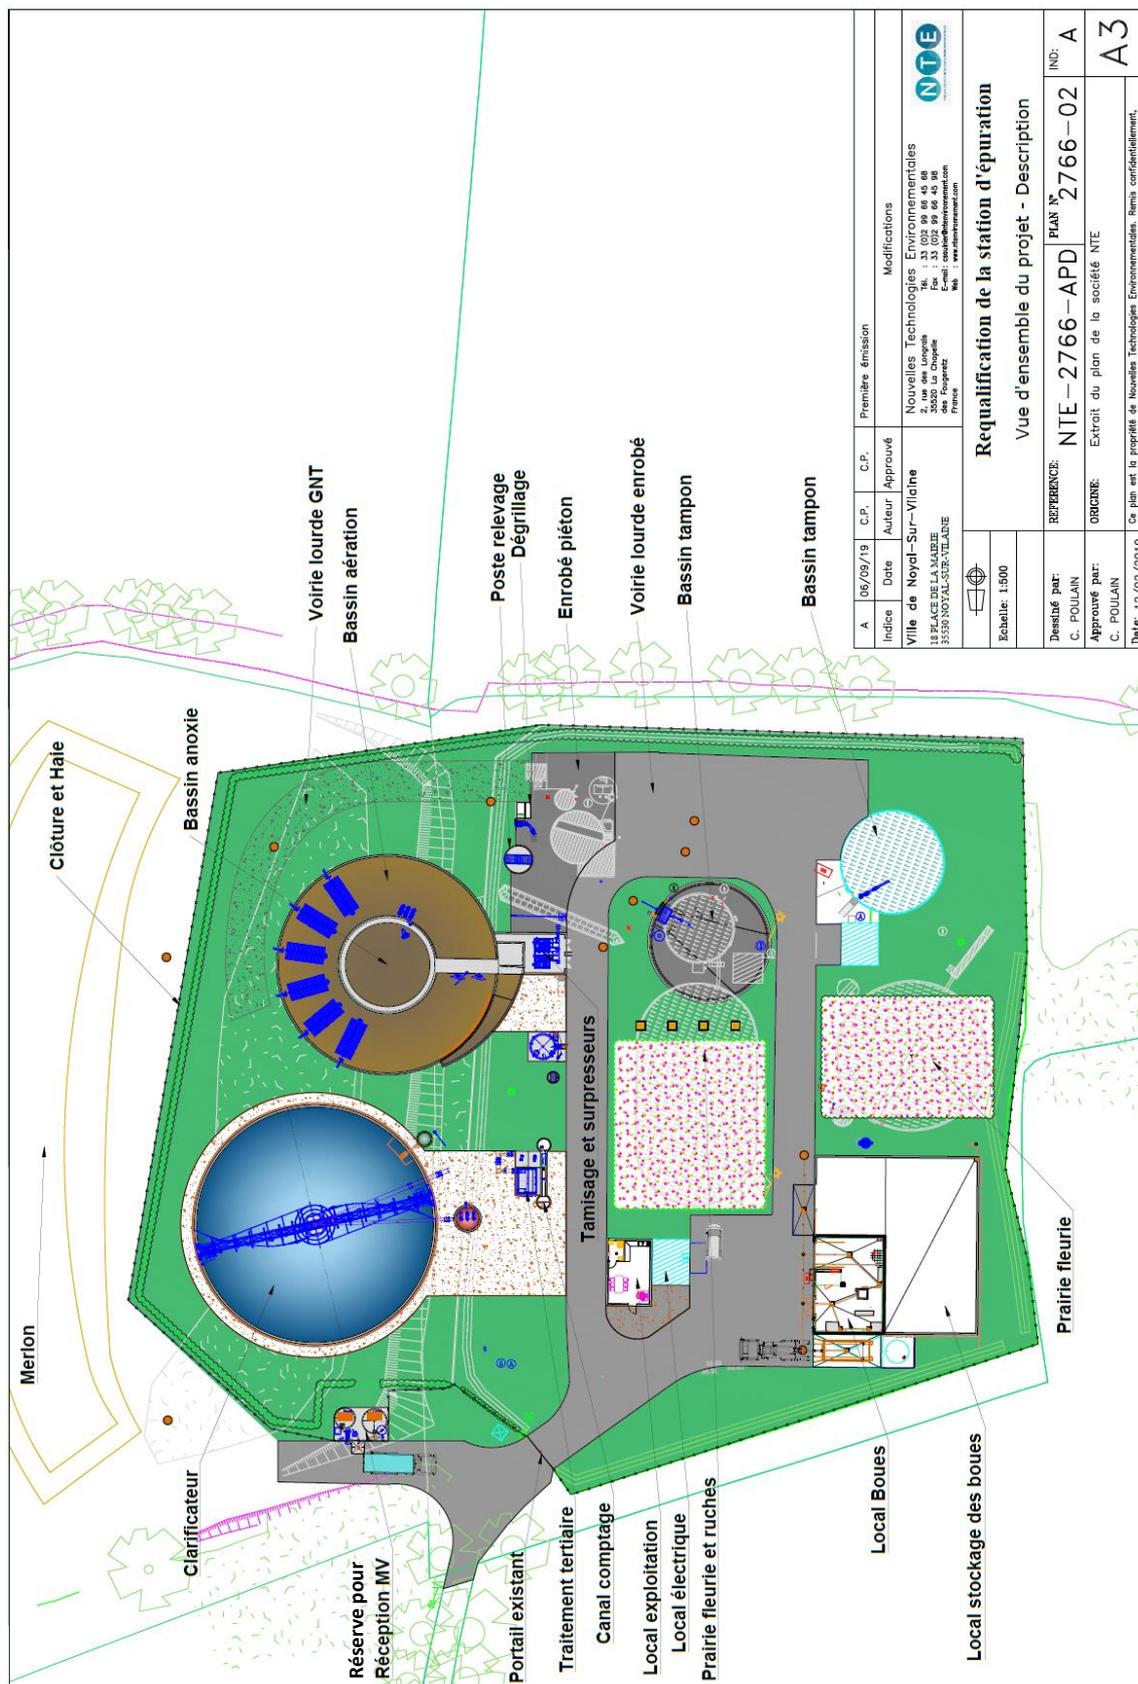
Plan d'implantation du projet (Vue d'ensemble)
